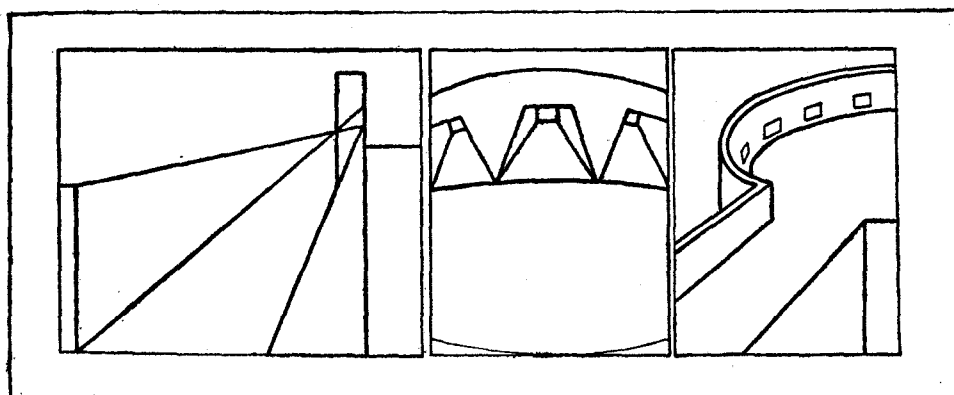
Reformas en los cubelos de la torre de Guanapay, proyectadas por Torriani.
